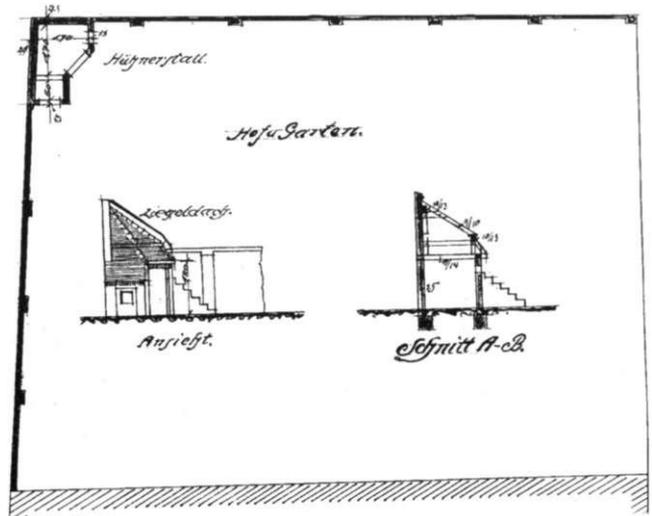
Hühnerstall, Schleiermacherstraße 1, 1910
